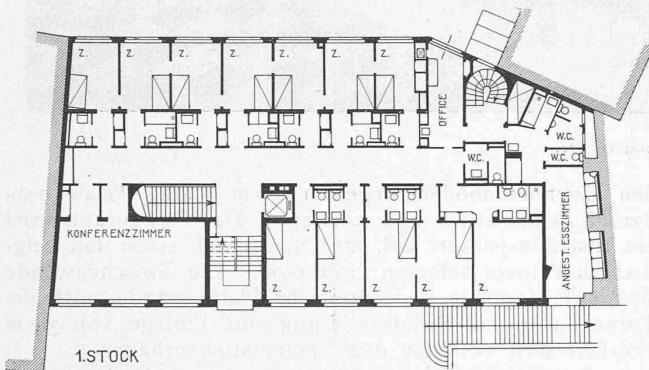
und 7. Grundrisse der Hotel-Wohngeschosse.
